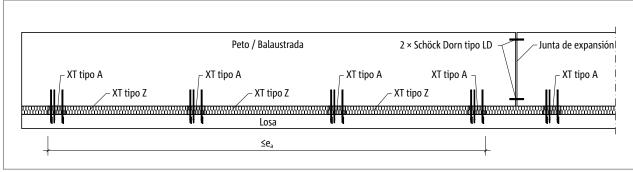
Schöck Isokorb® XT tipo A: Disposición de las juntas de expansión
